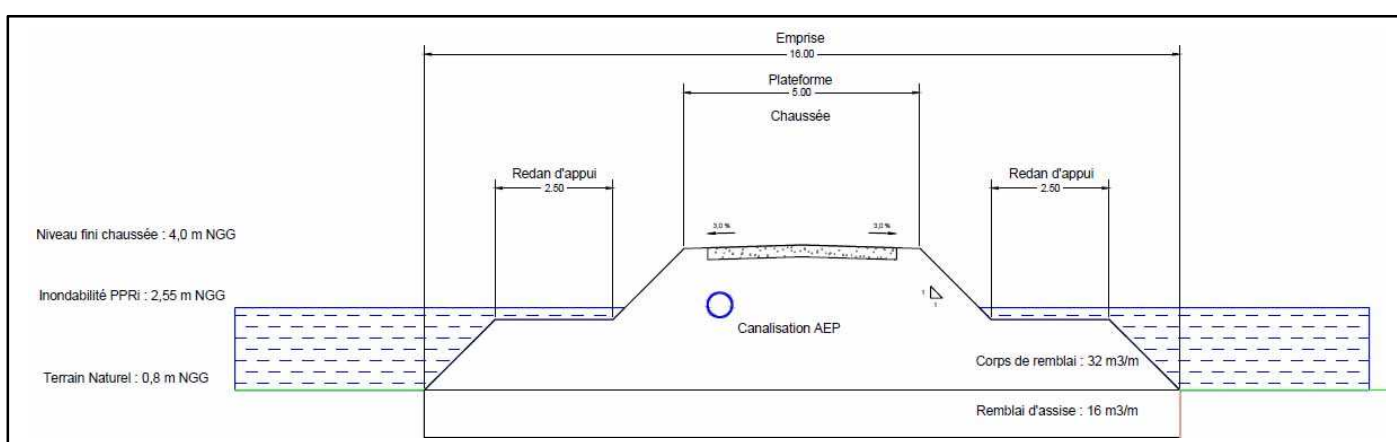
Profil en travers de la piste à réaliser en traversée de marais – SECOTEM
